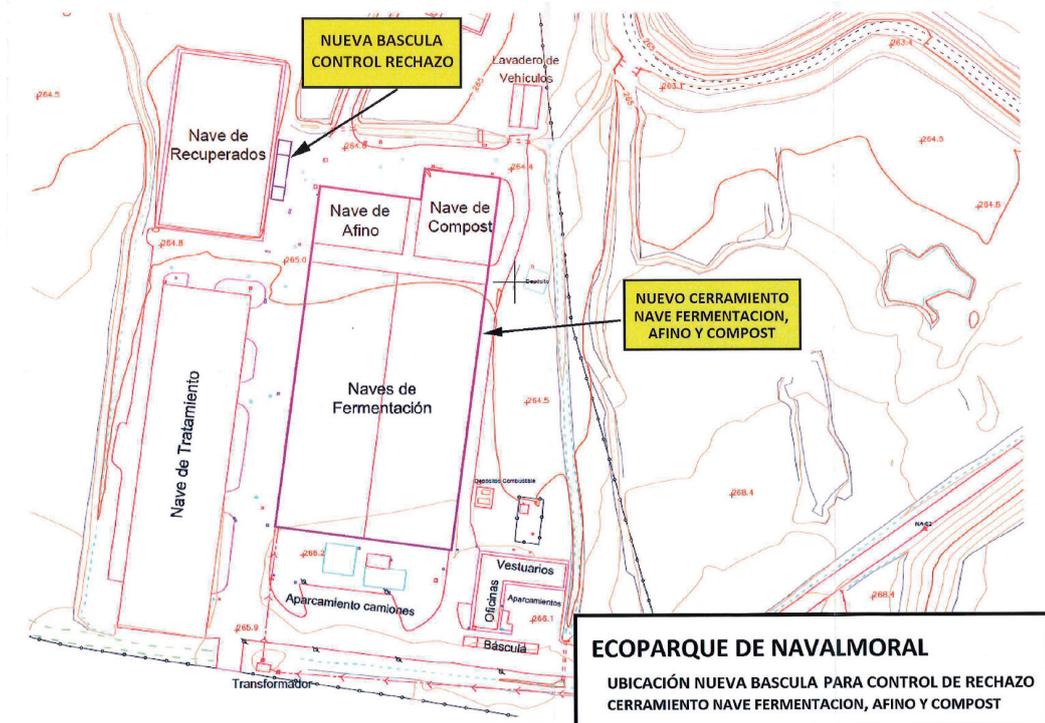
Plano 1 en planta de la instalación. Zona de tratamiento.
